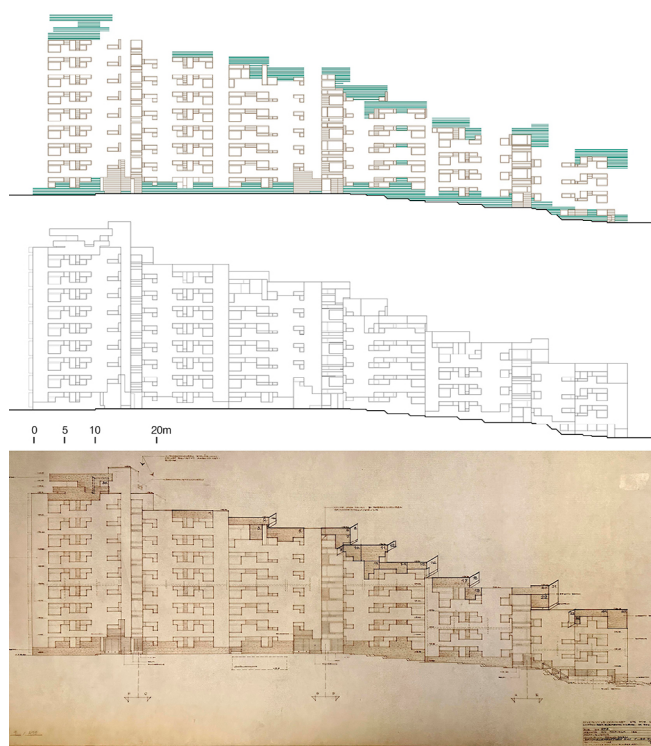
De arriba abajo: Descomposición material y geométrica del plano original del alzado norte del edificio septentrional. Ref. 9/0034. [Fuente: MFA; Elaboración propia]
